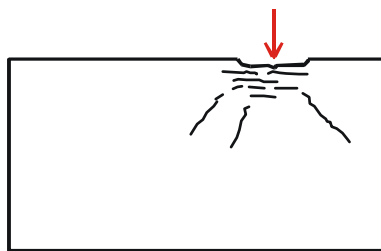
ruptura e fissuração de alvenaria sob ponto de aplicação de excessiva carga concentrada (THOMAZ, 1989)
